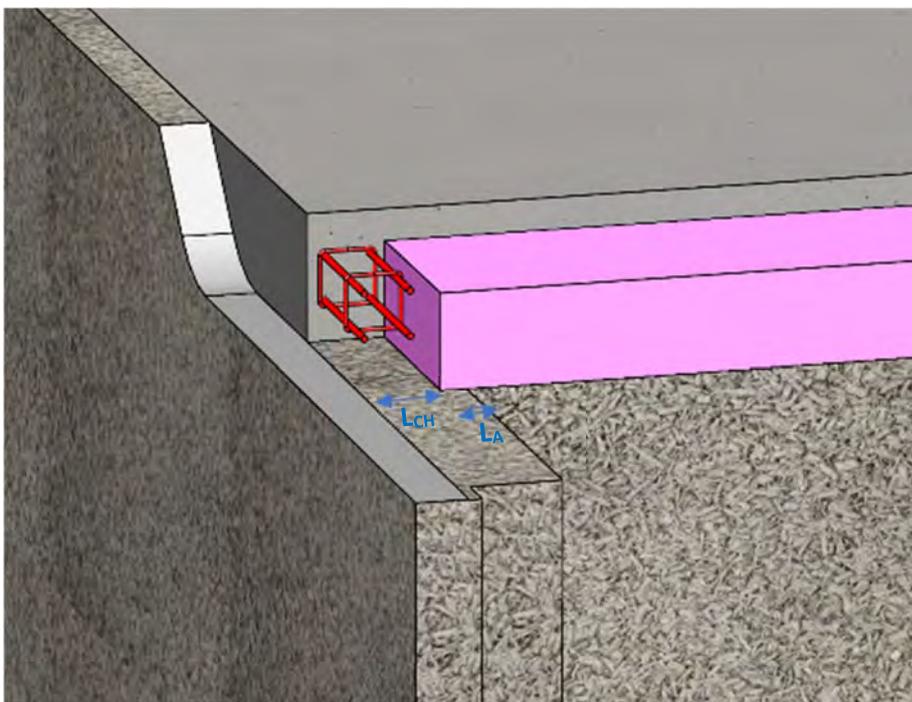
Appui des planchers sur mur CS2 TimberRoc
